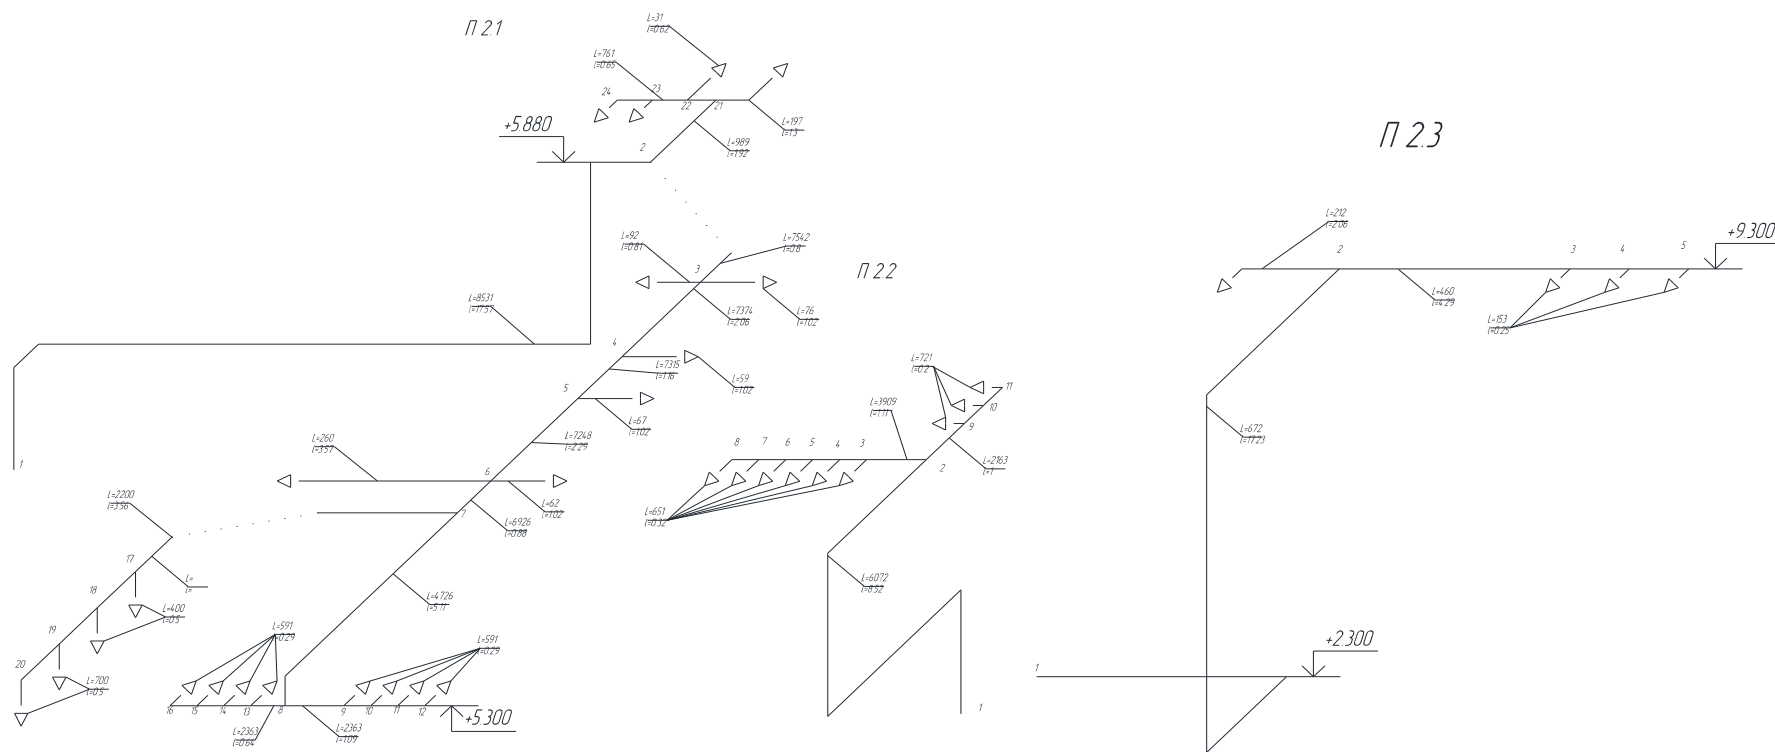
Расчетные схемы систем вентиляции блока №2
